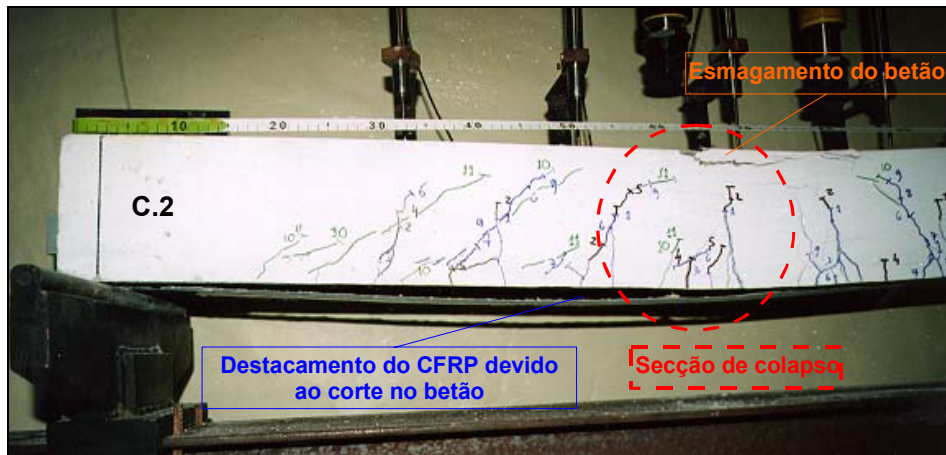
Ruína da viga C.2: esmagamento no betão; descolamento do laminado de CFRP.
